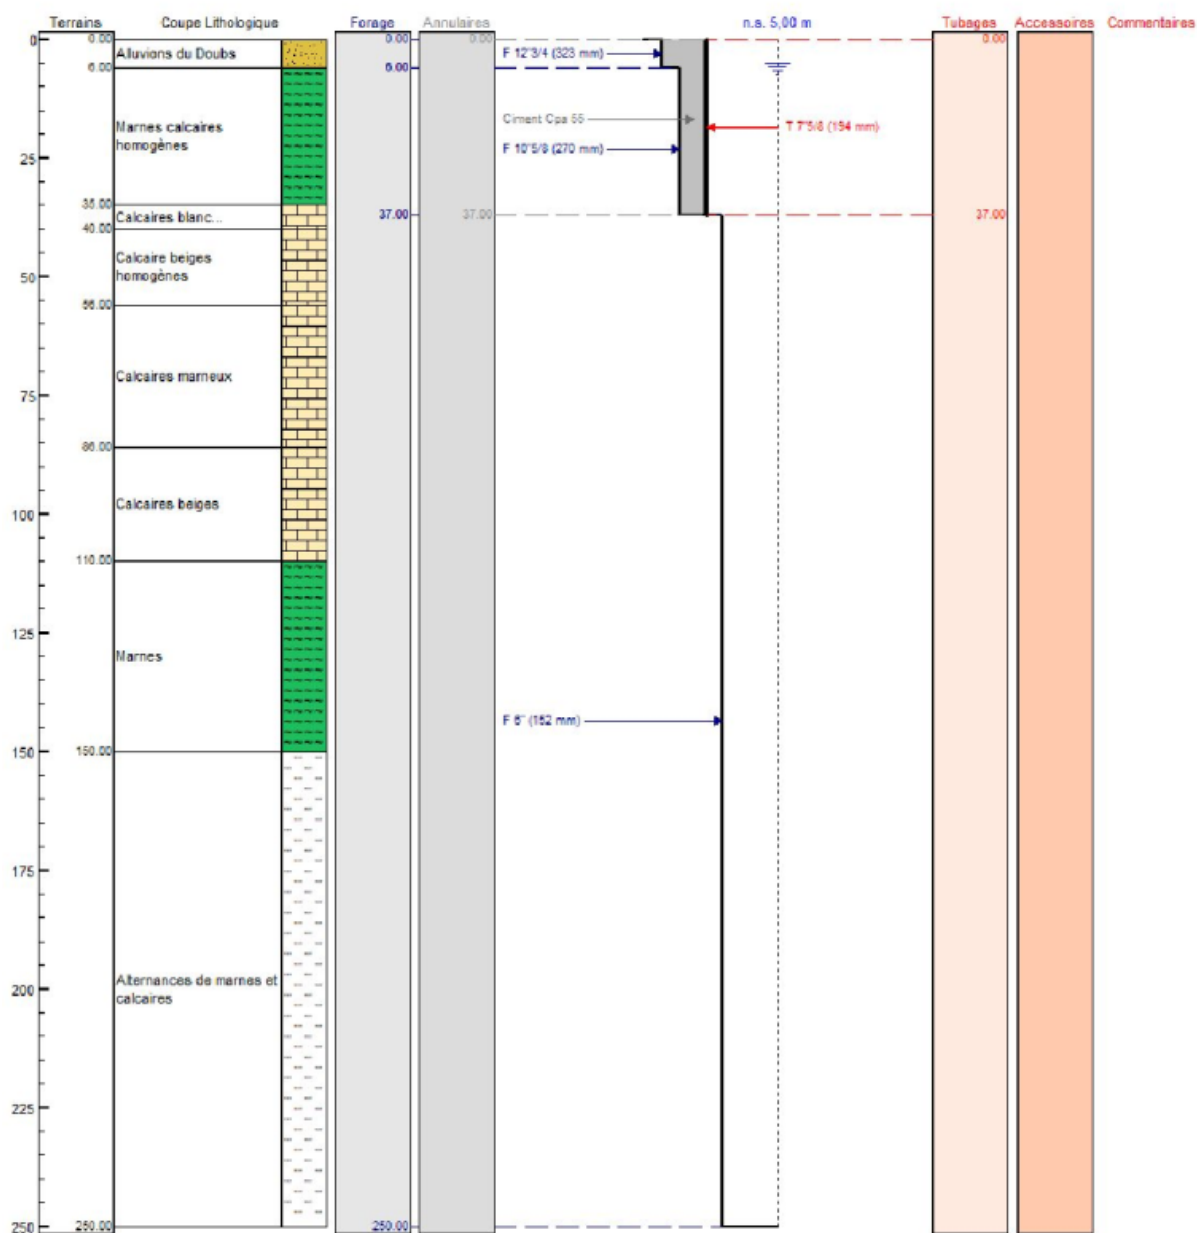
Architecture de puits prévisionnelle de l'ouvrage
